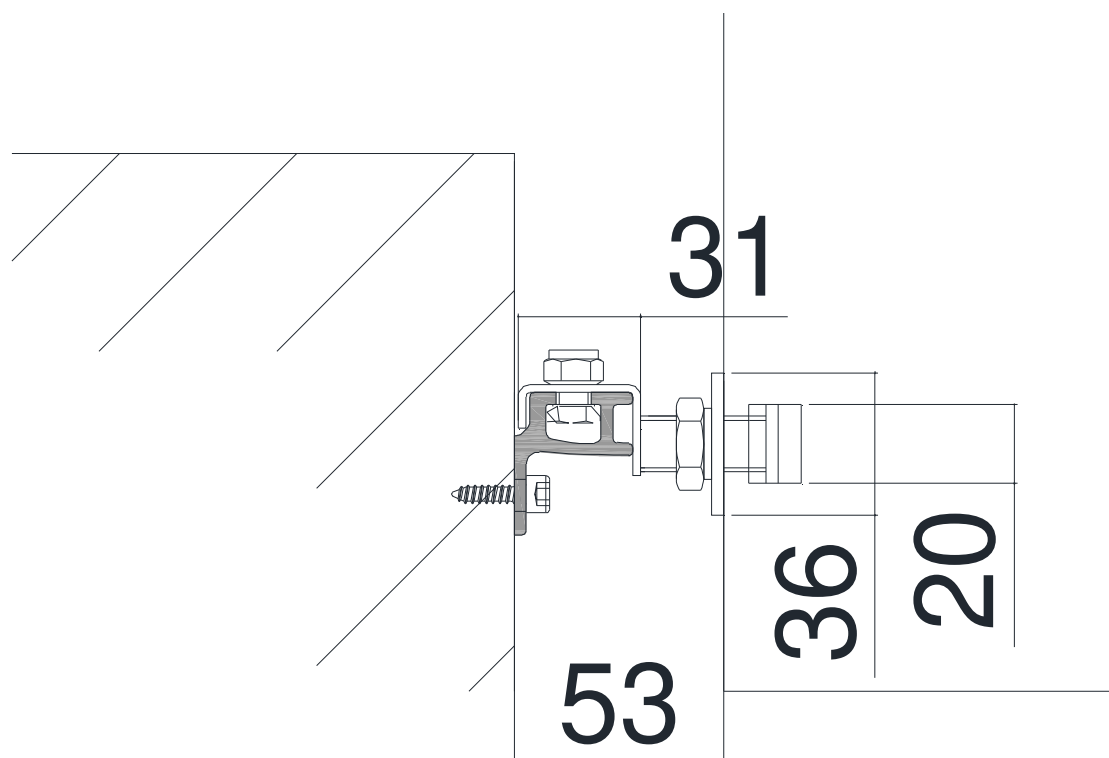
Sezione verticale del campione 1126-24-IR sottoposto a prova - dettaglio fissaggio
